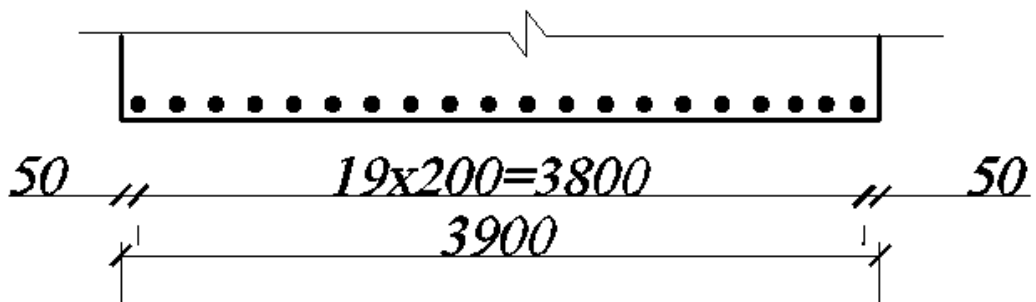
Схема армування плитної частини вздовж меншої сторони
